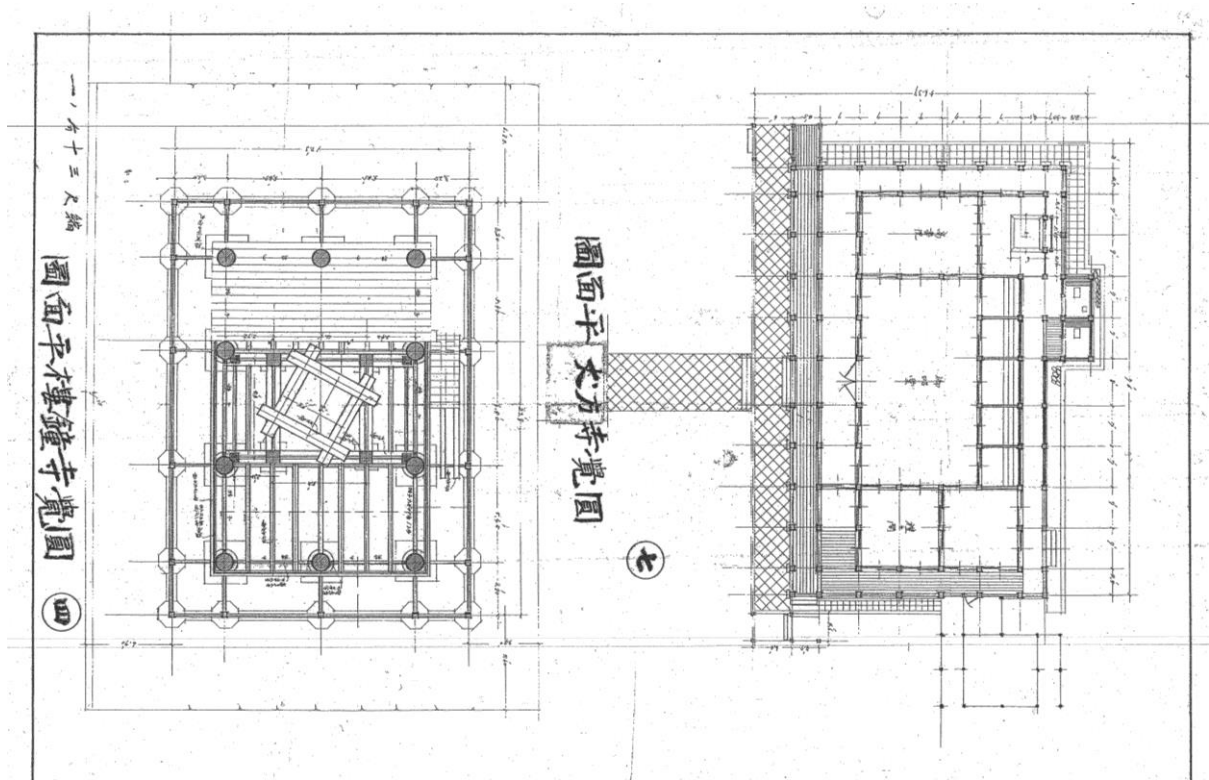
四 圓覺寺鐘樓平面圖 七 圓覺寺方丈平面圖
